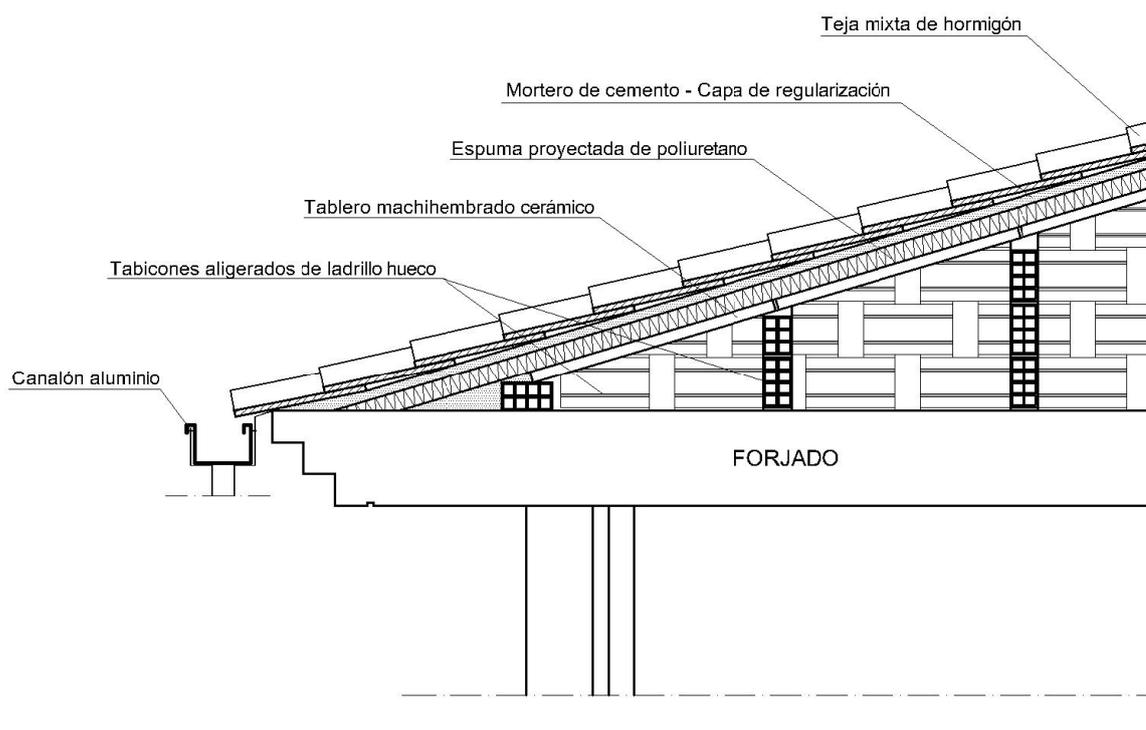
Sección cubierta ejecutada – Cubierta caliente
